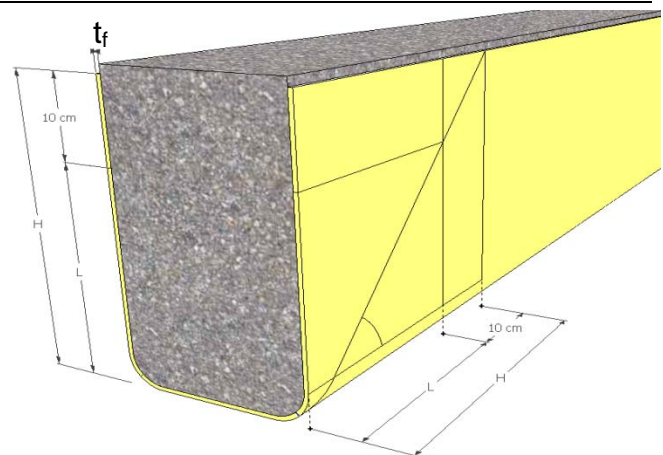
Schéma d'une poutre renforcée avec le composite SikaWrap
